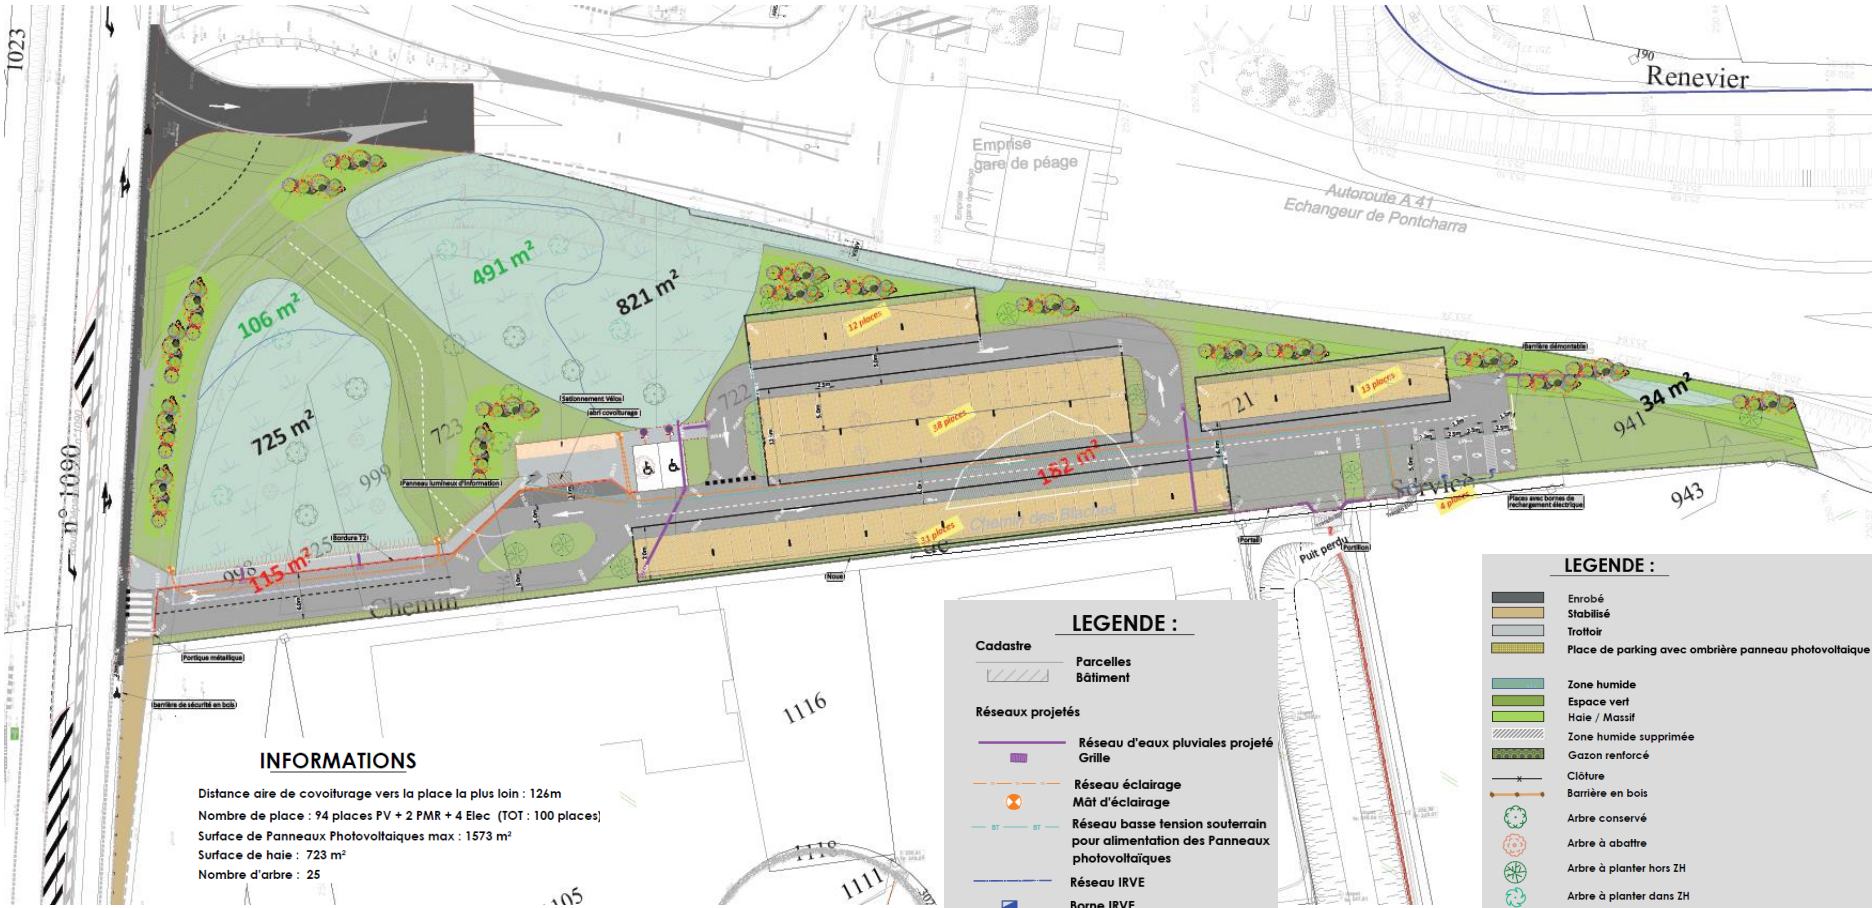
Plan de masse parking de covoiturage (Source : Profils études)
